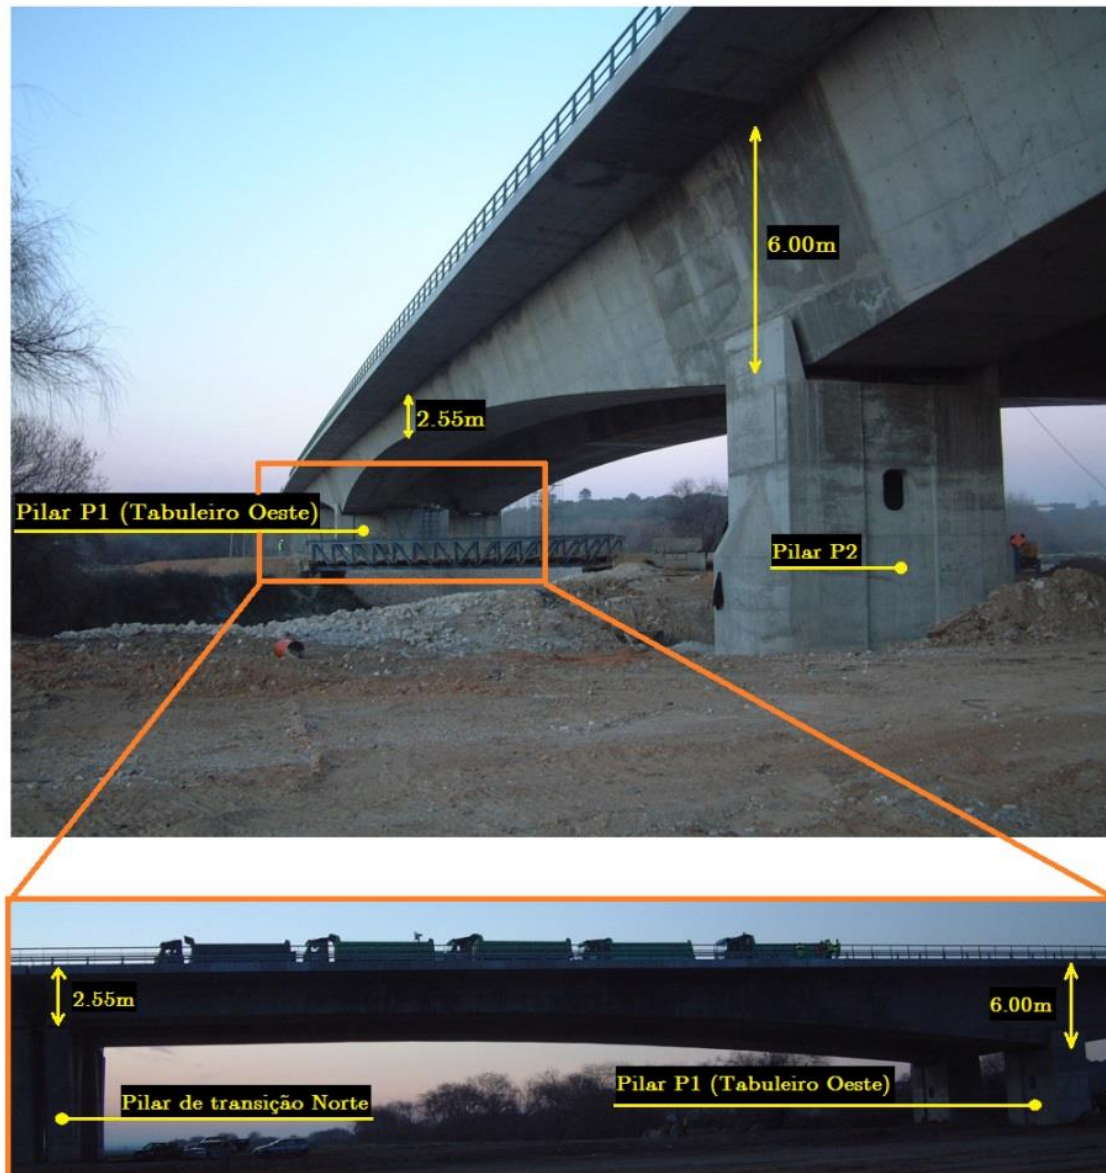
Pormenor do tabuleiro da ponte sobre o rio Sorraia
